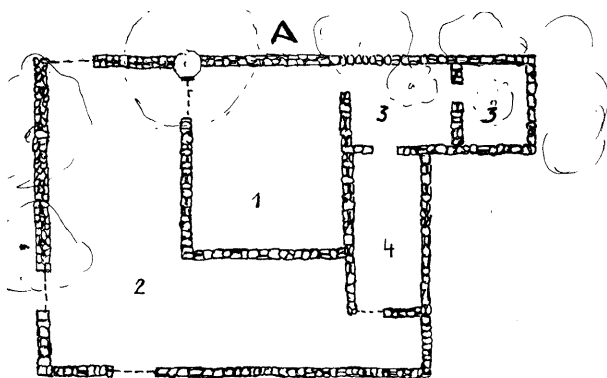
Margar za strižnju. Razlučivanje ovaca prije strižnje.
